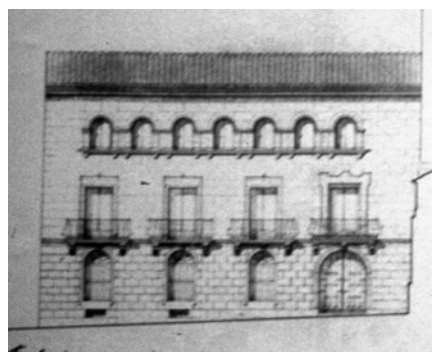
Proyecto de C. M. Sta. María de los Ángeles: fachada a plaza de Anaya, por Fernando Población, mayo 1954.
